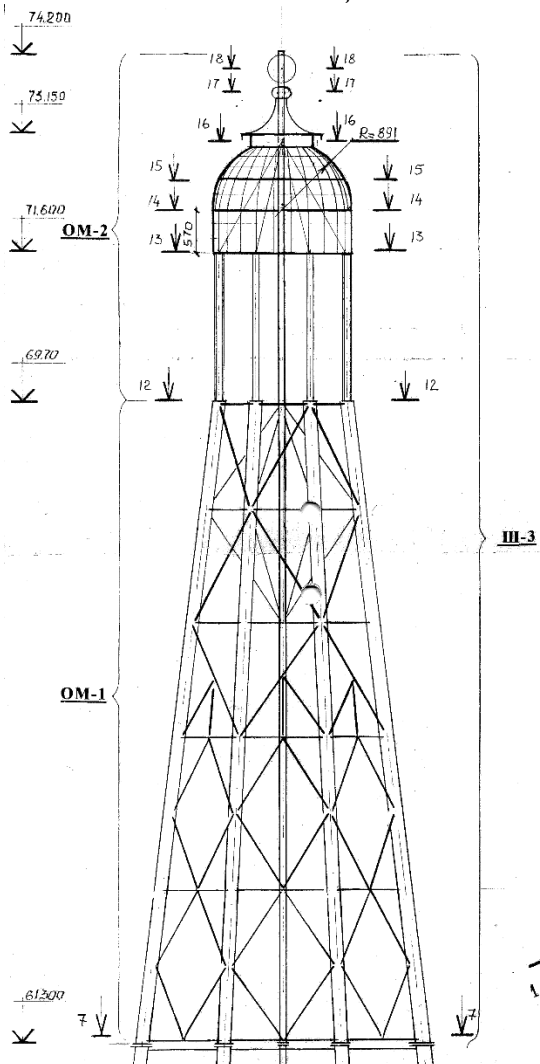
Креслення металевих конструкцій верхньої частини шпиля дзвіниці
